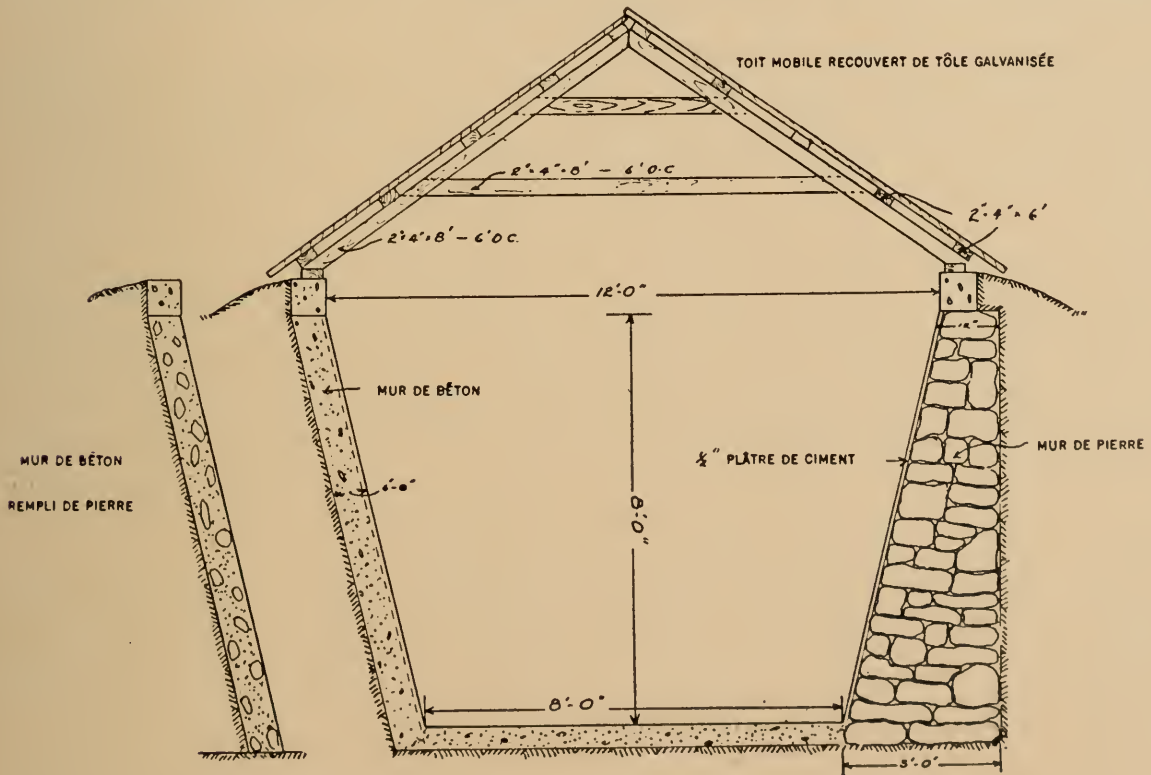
Schéma d'un silo-fosse montrant trois types de construction des murs et un toit portatif construit en sections.
